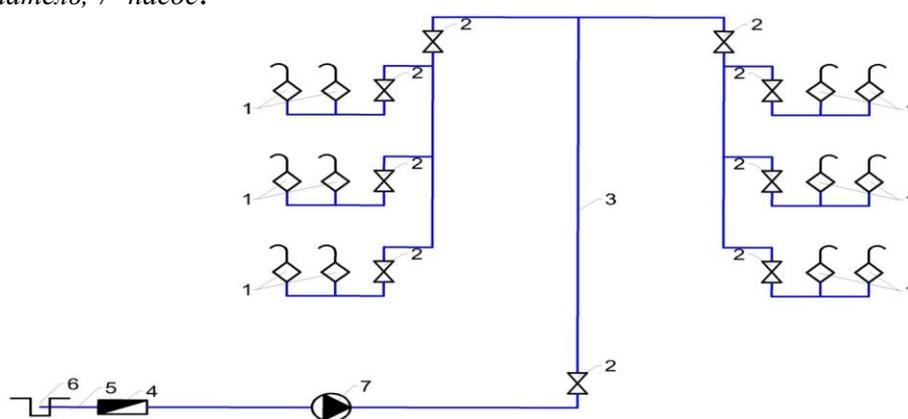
Схема внутреннего водоснабжения с верхней разводкой.
